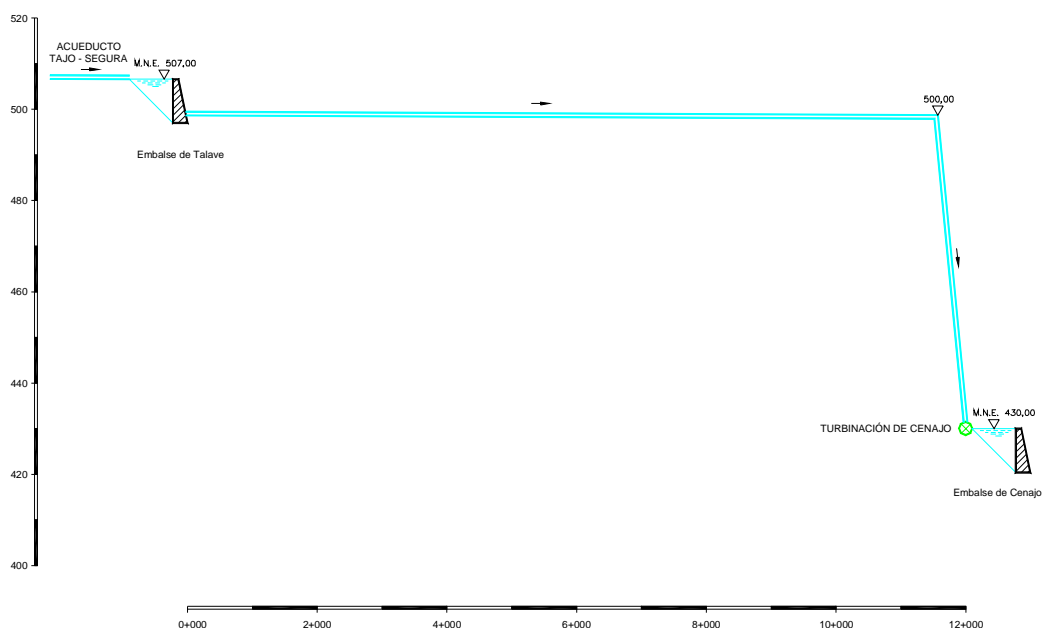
Conducción Talave-Cenajo. Esquema en alzado
